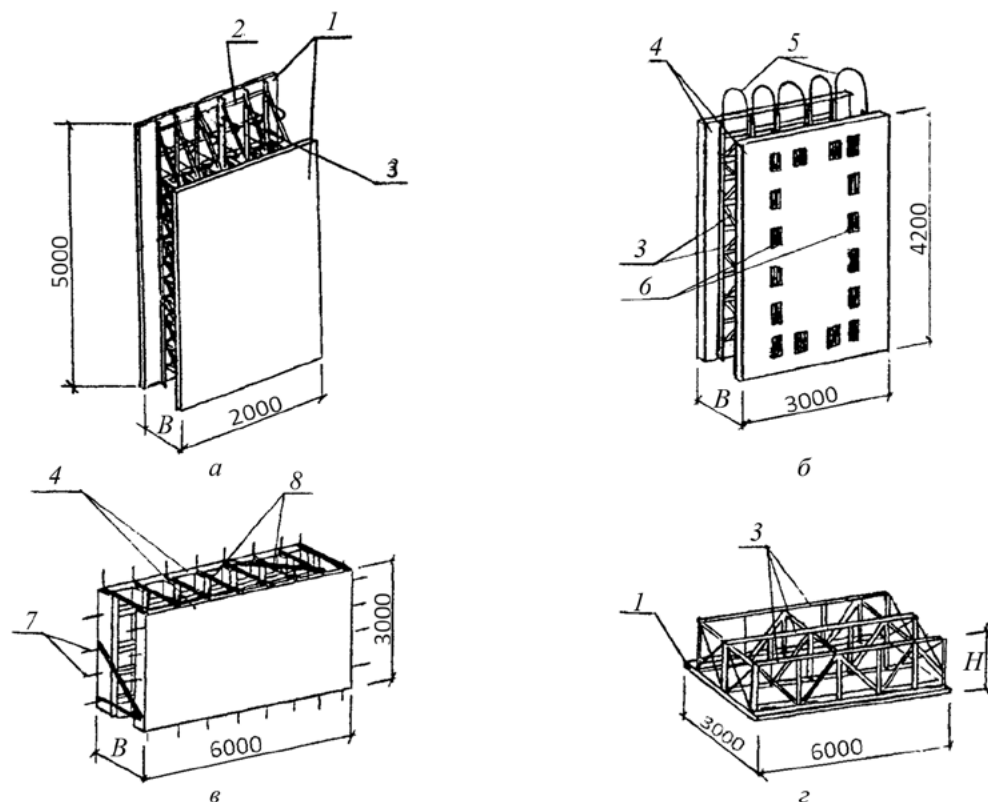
Примеры решений стеновых блоков с облицовкой-опалубкой: *a* — из стального листа; *б* — из плоских железобетонных плит; *в* — из ребристых железобетонных плит с выпусками арматуры; *г* — из блоков перекрытий сборно-монолитных конструкций с облицовкой-опалубкой из стального листа; *1* — стальной лист; *2* — уголок, приваренный к листу; *3* — элемент армометаллического каркаса; *4* — железобетонные плиты; *5* — петлевые выпуски арматуры; *6* — закладные элементы; *7* — выпуски арматуры из плиты; *8* — связи из уголков
